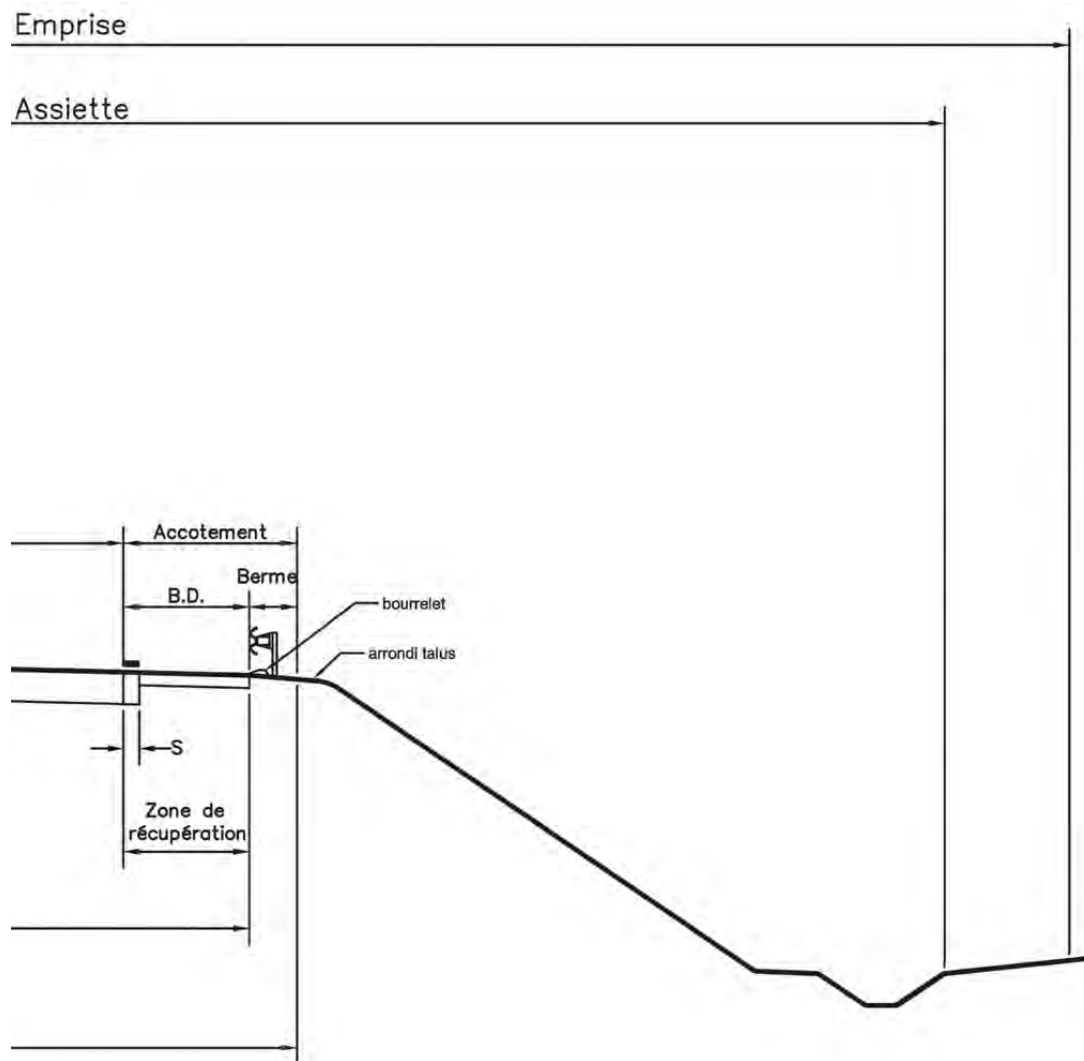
Profil en travers d'une route à chaussée unique (2 ou 3 voies).
